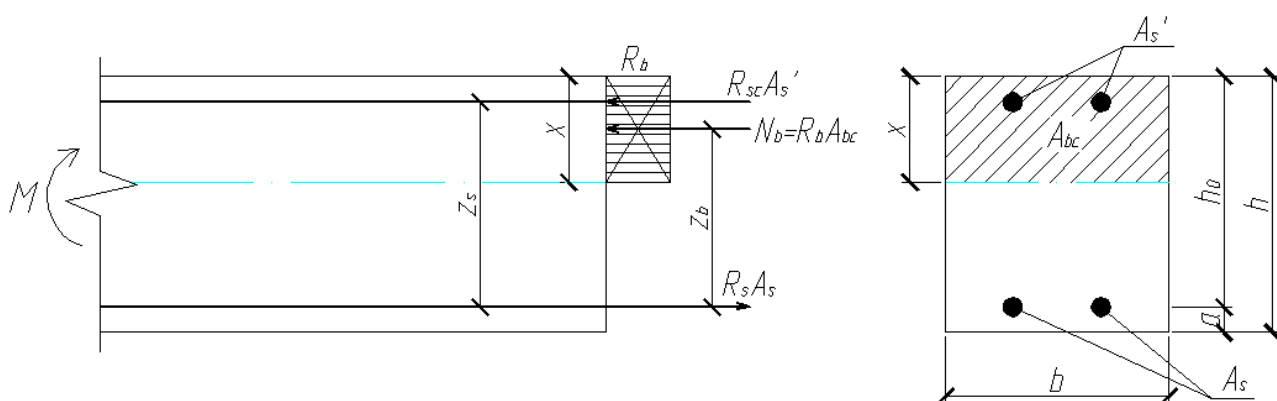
Схема внутренних усилий второстепенной балки в пролете
